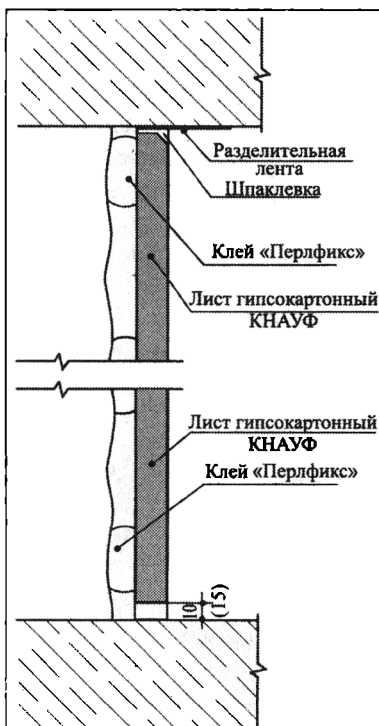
Крепление ГКЛ к стенам с неровностями до 20 мм
